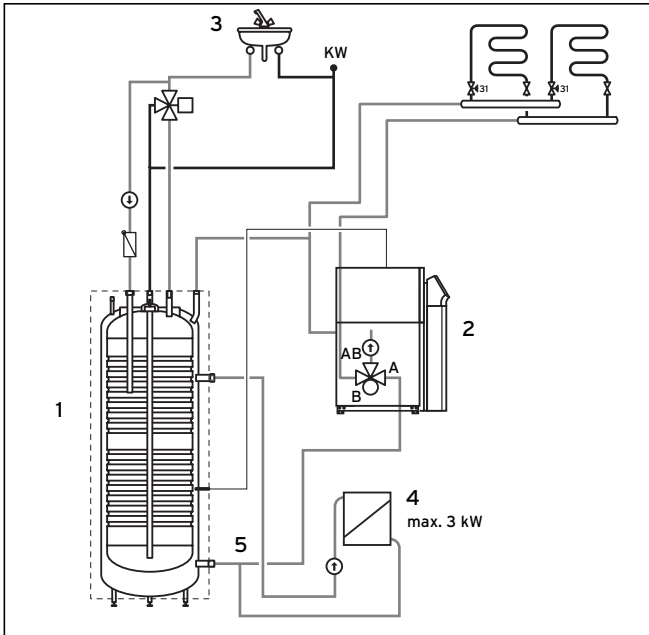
Installation du ballon d'eau chaude sanitaire avec radiateur additionnel
